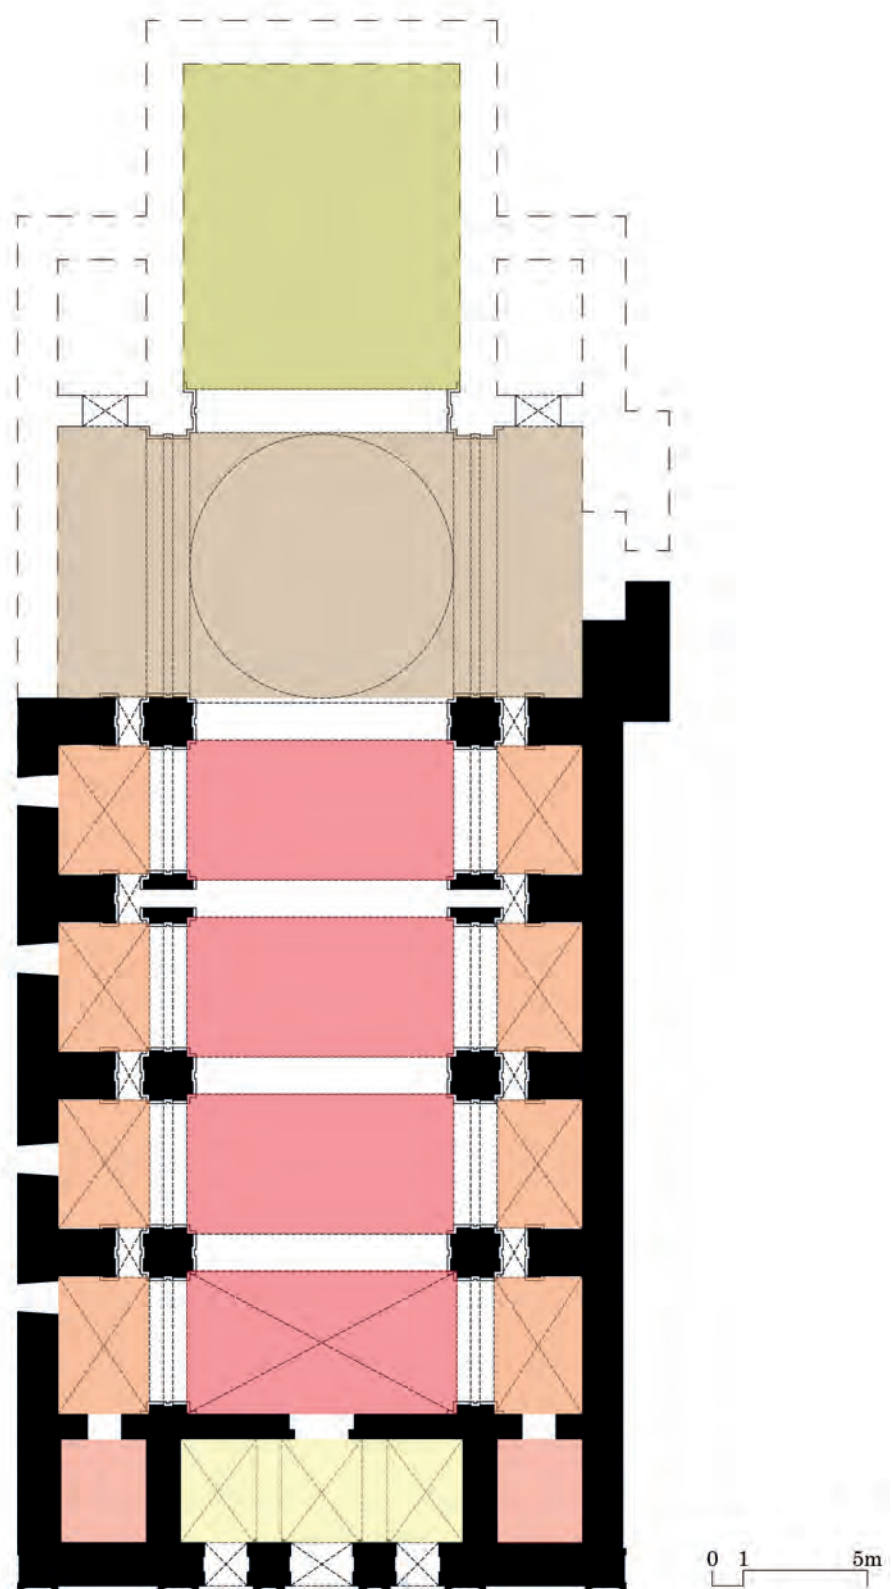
| Reconstituição da planta da igreja de Santa Maria de Seica
